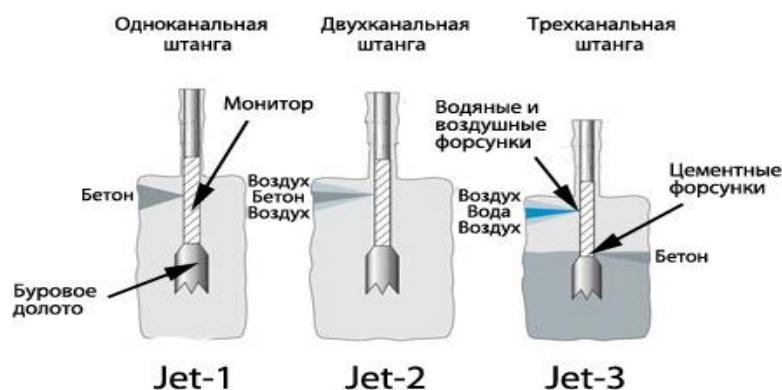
Создание грунтобетона с помощью систем Jet-1, Jet-2 и Jet-3.
